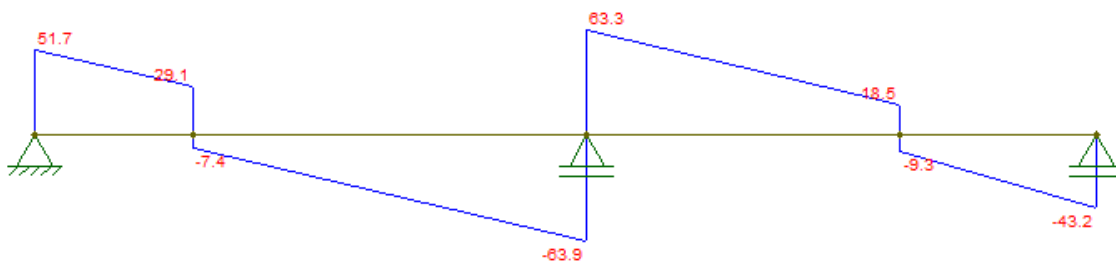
Reações de apoio - Viga 8 (a e b) (Tipo).
